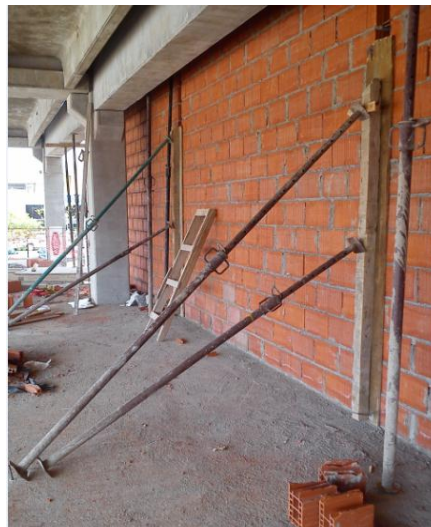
Mampostería. Preparación del encofrado para llenar encadenados.
